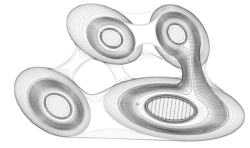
Planta Galaxy SOHO, Zaha Hadid.
